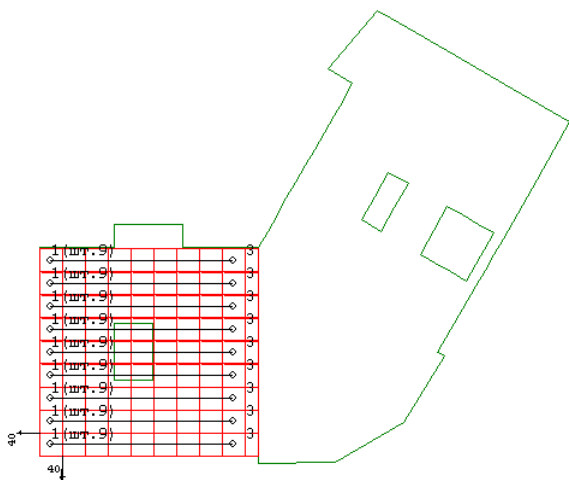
Схема раскладки сеток у верхней грани плиты, участок 1 (фрагмент)
